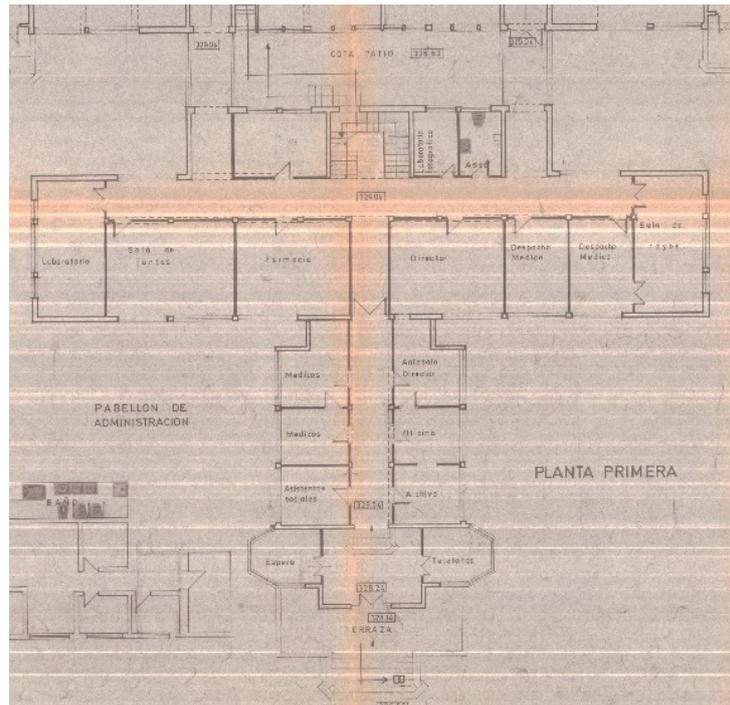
Planta primera del Pabellón General, año 1977. Fuente. Fondos del Cabildo de G.C.
